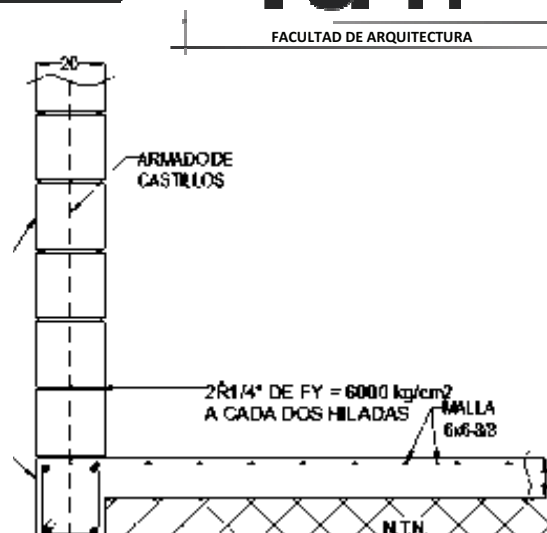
DETALLE DE BLOCK HUECO DE CONCRETO
